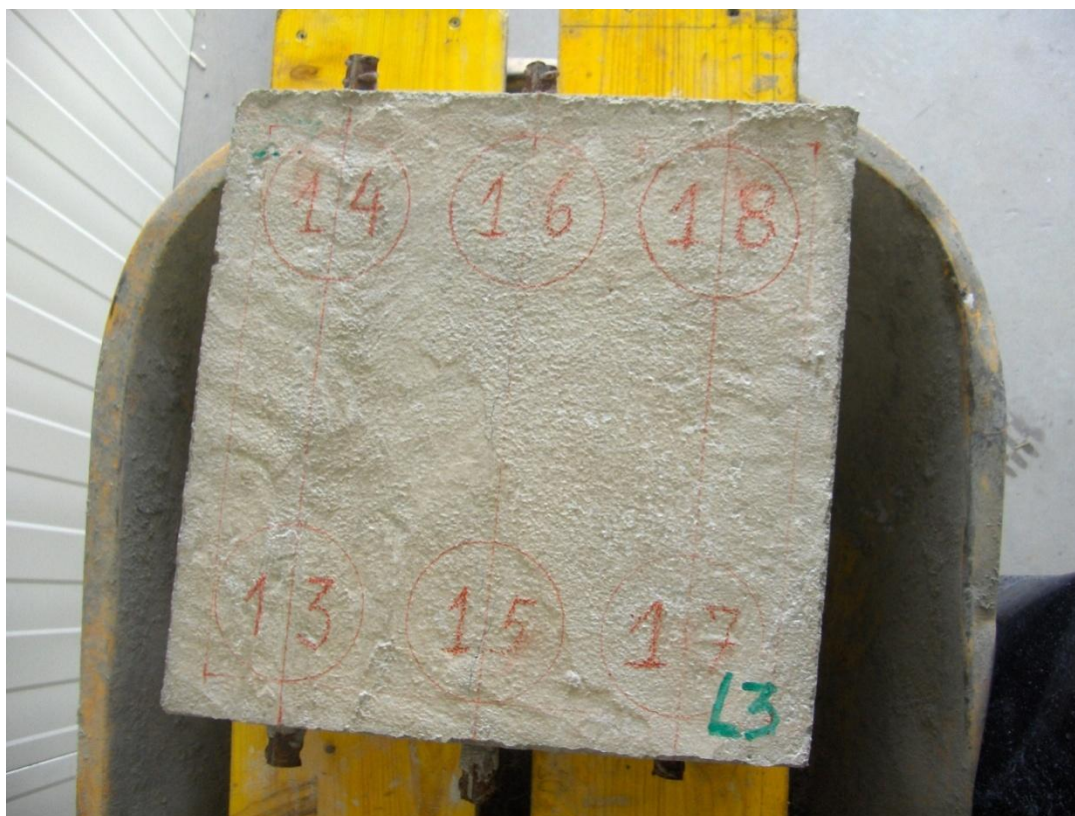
Lajeta L3 e carotes por extrair de 13 a 17
